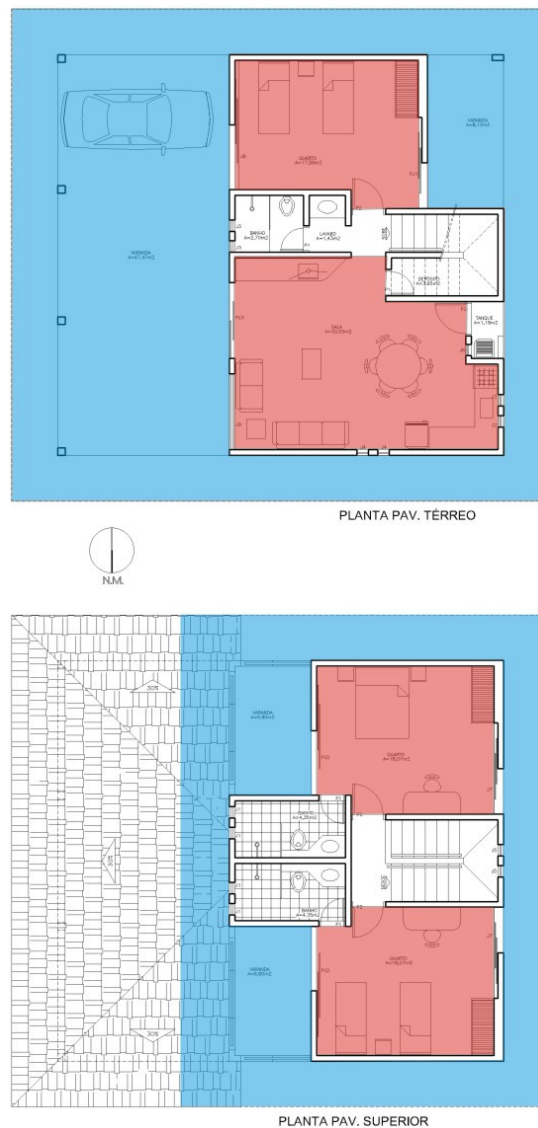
Projeto 4 - Setorização e Beirais - Plantas
